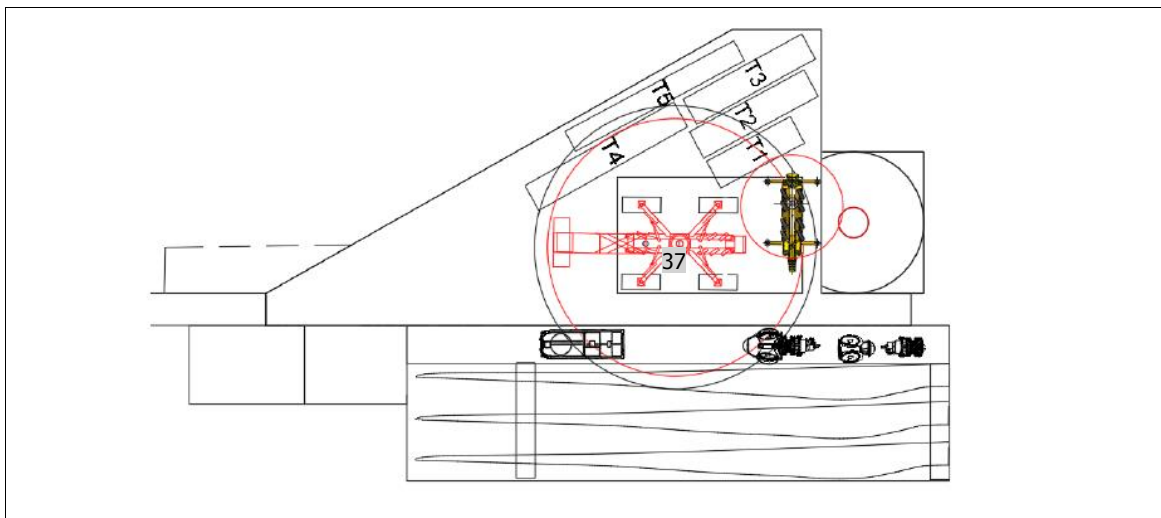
configurazione piazzola tipo in fase di cantiere (in rosso la piazzola definitiva)
